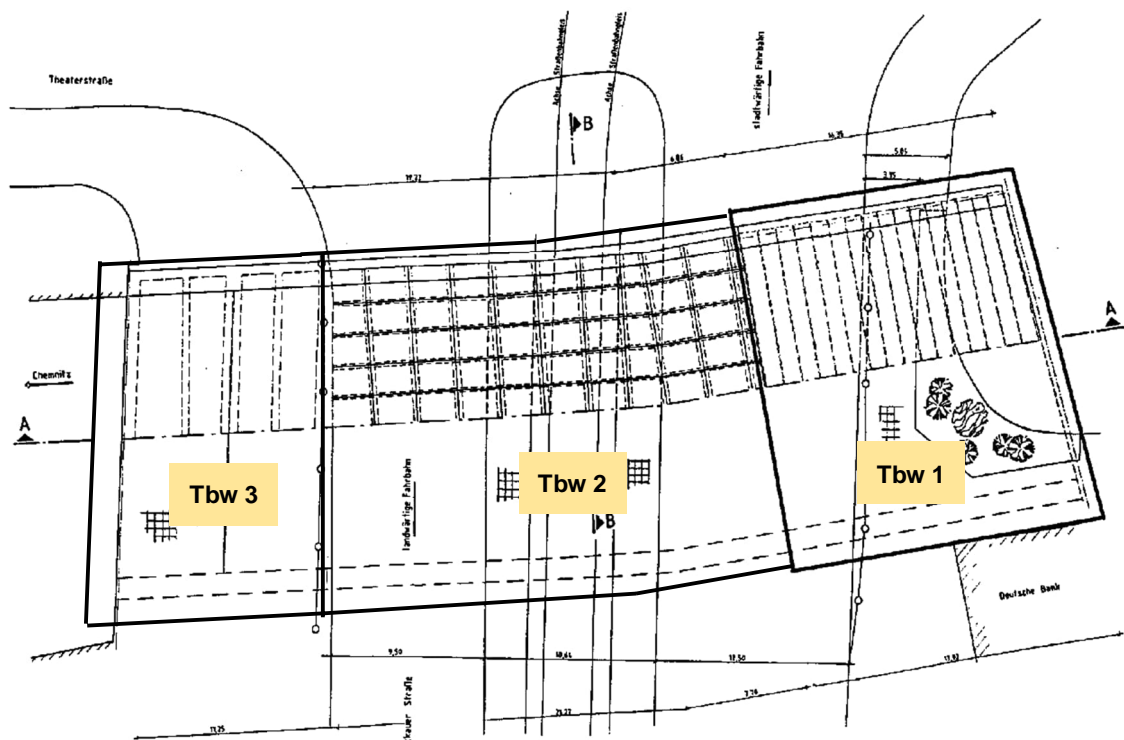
Brücke Falkeplatz Bestand mit Teilbauwerk (Tbw) 1 bis 3 - Grundriss¹¹
